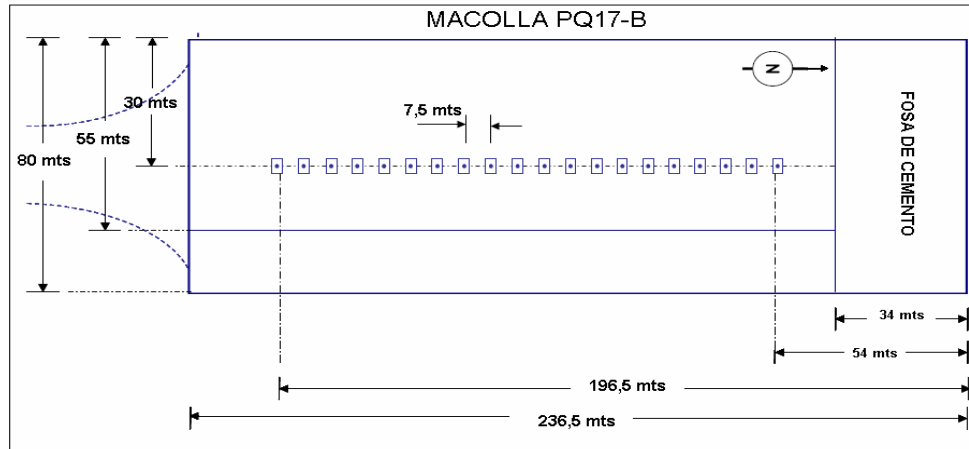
Vista en planta de la Macolla PQ17-B ubicada en el Distrito Cabrutica.
